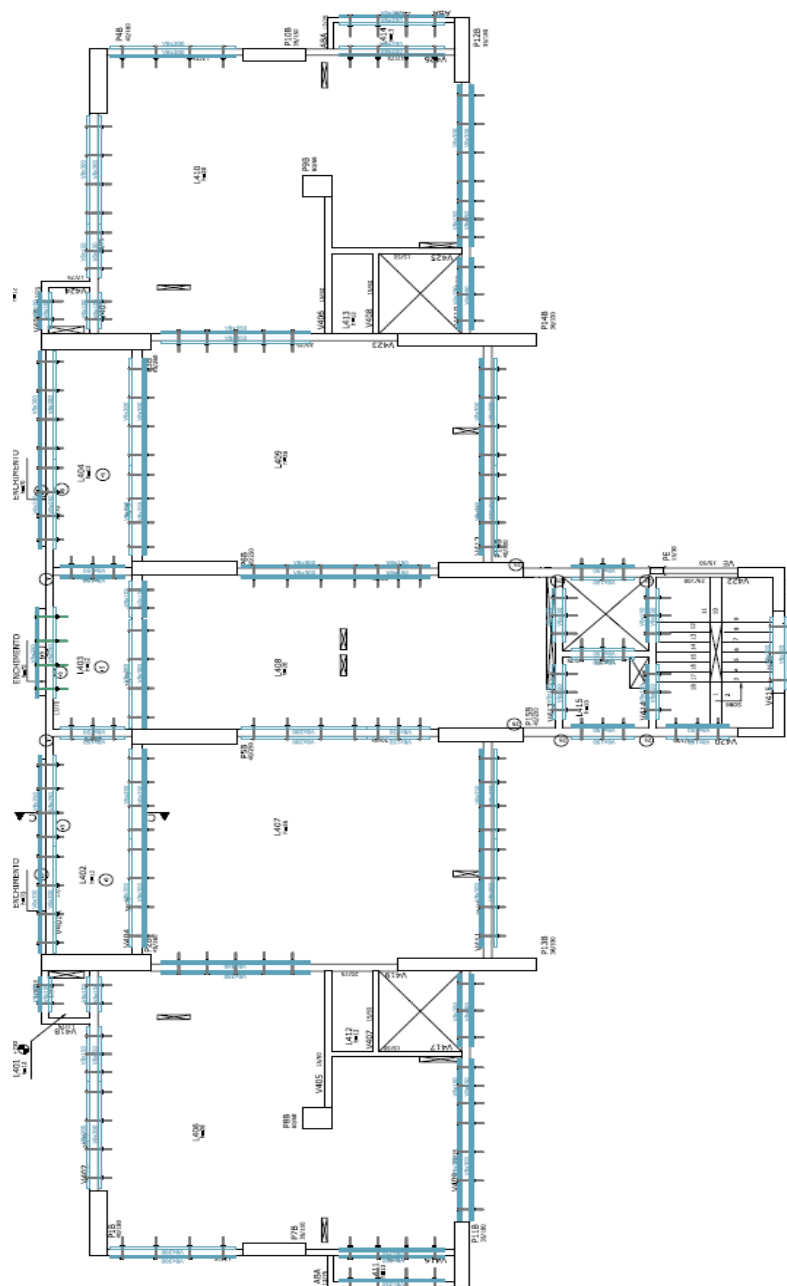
Esquema de escoramento em vigas – Torre A.
